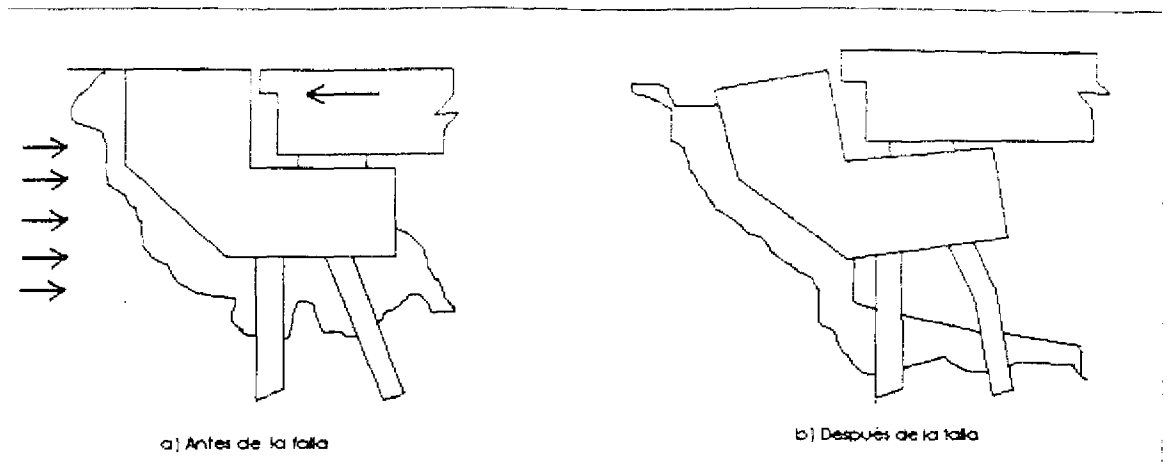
Detalle de apoyo en pila central del puente sobre el Río Bananito.
